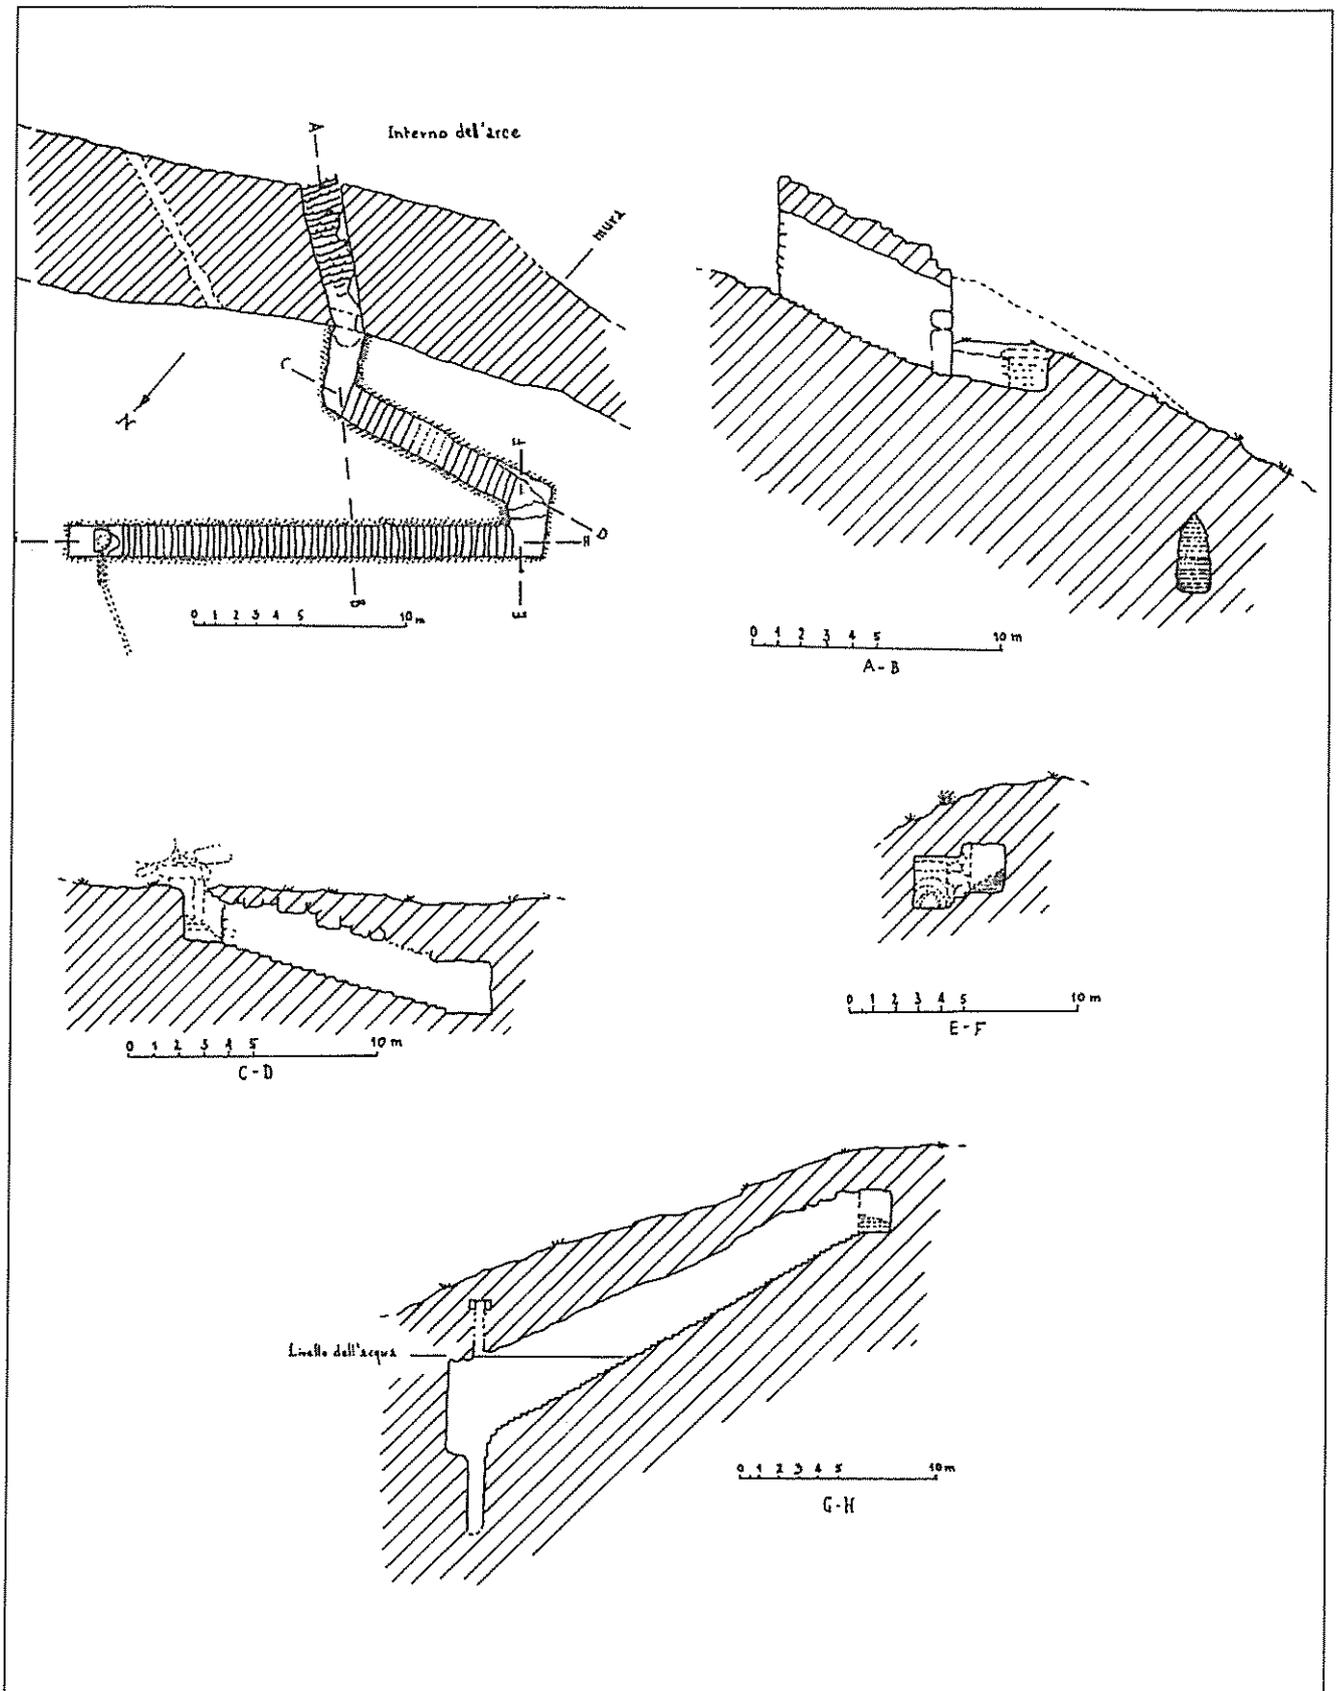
Micene. Planimetria e sezioni della Fonte Perseia, la principale possibilità di approvvigionamento idrico della famosa cittadella achea dell'Argolide. Il sistema, completamente sotterraneo e tuttora funzionante, permetteva di accedere alla sorgente, posta fuori delle mura, al coperto dall'azione di eventuali nemici. [Ridisegnato da KARO 1934, tavv. XII-XIII].
